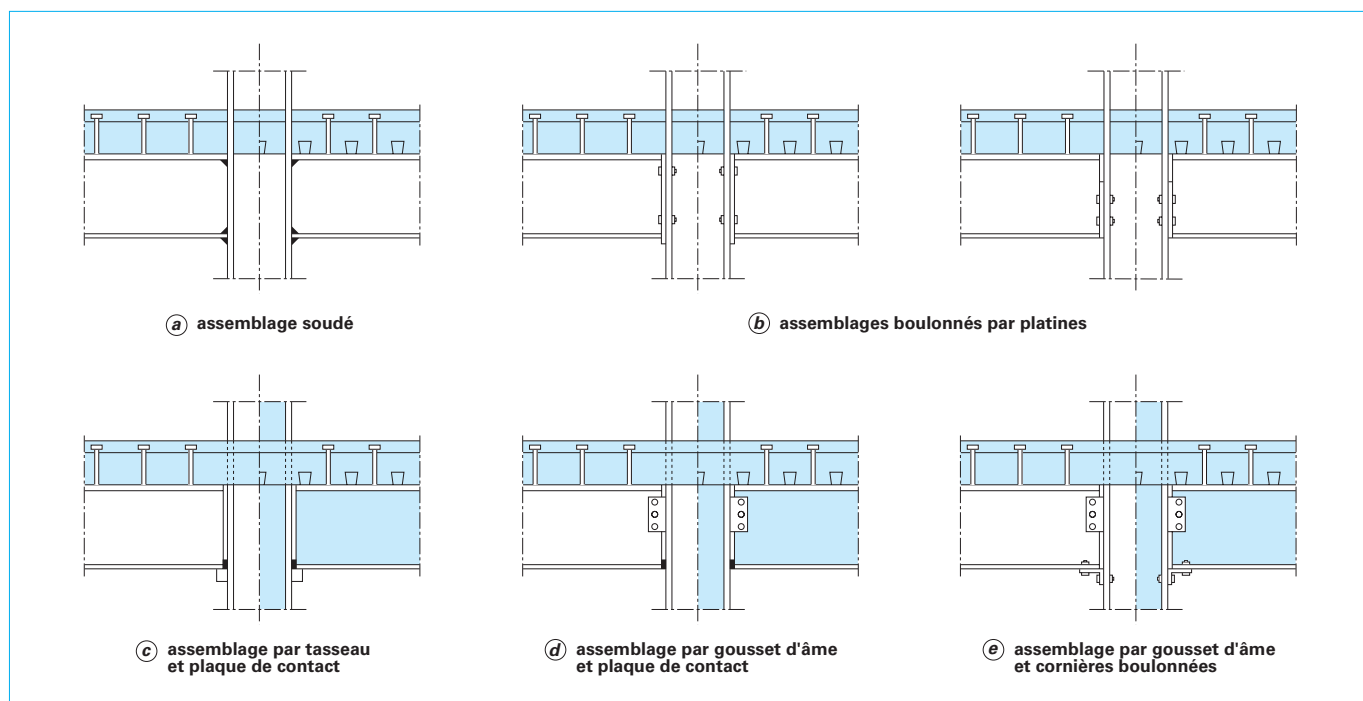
Assemblages de type poutre-poteau pour des ossatures mixtes semi-continues
